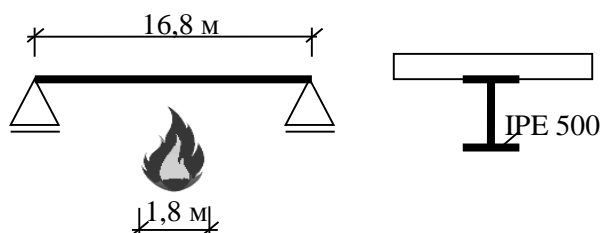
Расчетная схема и поперечное сечение балки перекрытия
